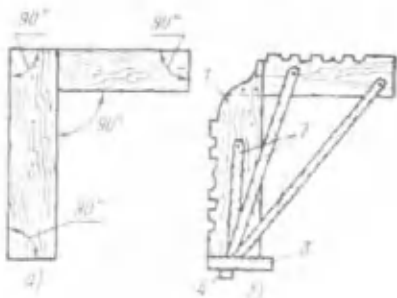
Изготовление большого шаблона: а — заготовка, б — шаблон; 7 — профильная доска, 2 — подкосы, 3 — салазки, 4 — полозок
